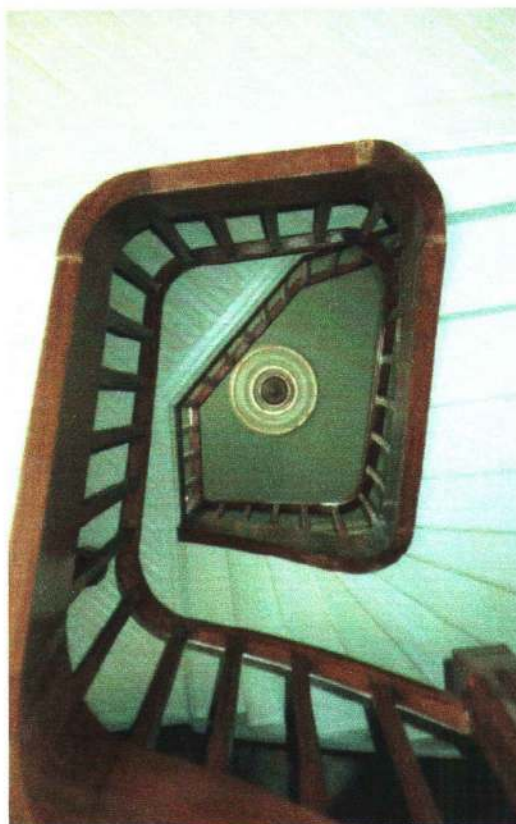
Escadaria de acesso ao terceiro e quarto pavimentos vista de baixo para cima – destaque para o forro em estuque (Fonte: Autor).
